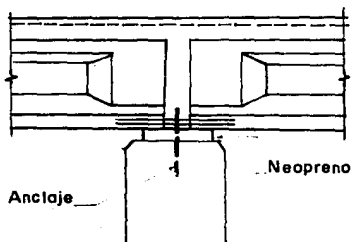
Detalle de soporte y conexión sobre las pilas
